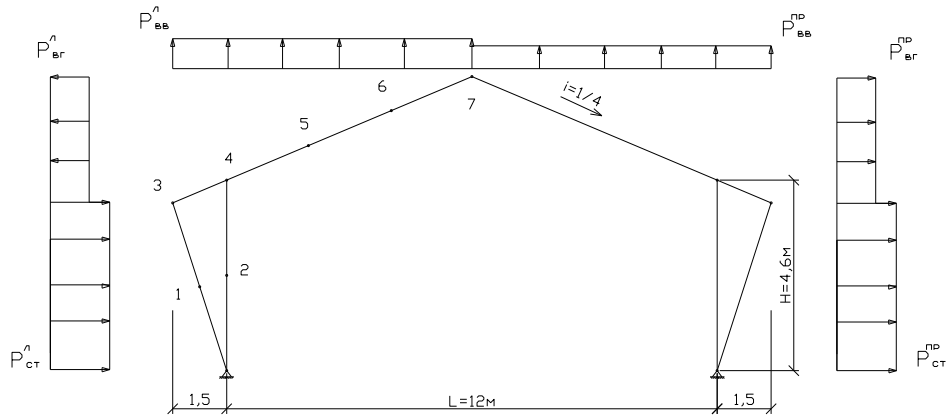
Расчетная схема рамы с характерными точками, для расчета ветровой нагрузки
